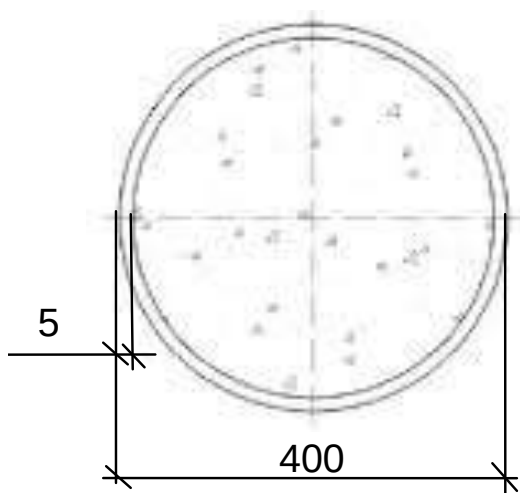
Структурна схема перерізу трубобетонної колони
